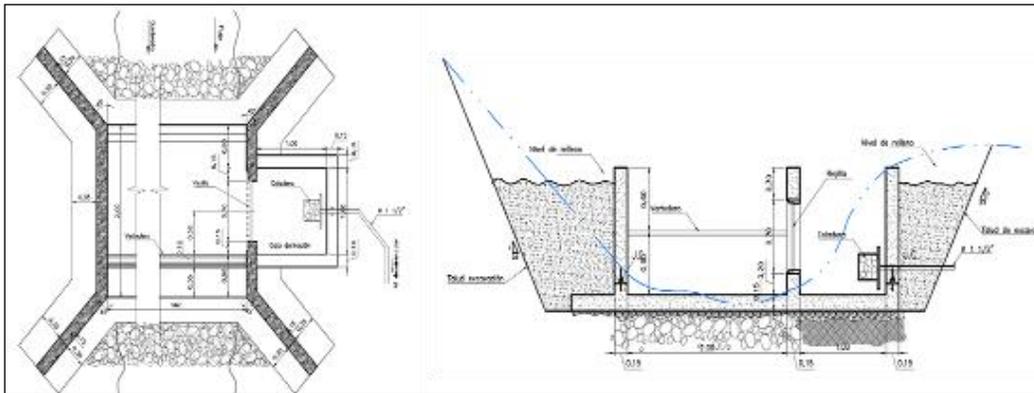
Vista en planta y corte de la estructura tipo de captación bocatoma lateral
